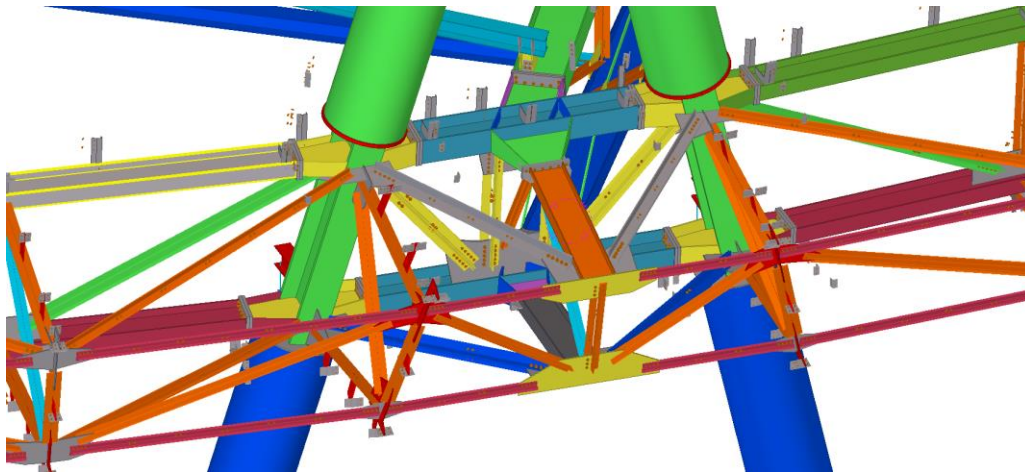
Detalle de nudo viga columna. Modelo BIM para detallamiento.
